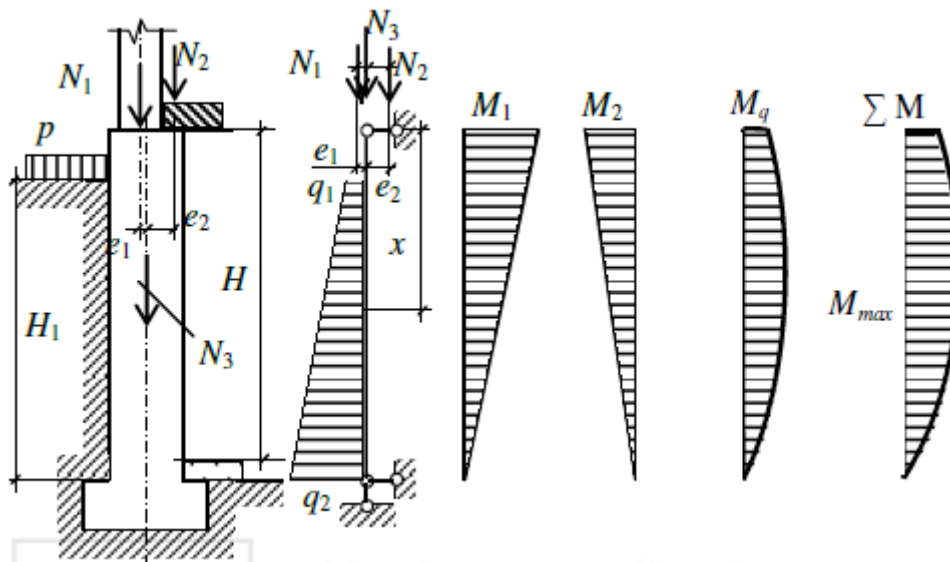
Схема навантажень на стіну підвалу та епюри моментів ([7], рис. 4.10)
